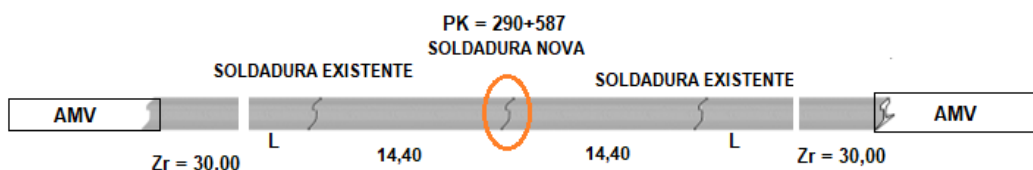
Soldadura no sub-troço R1.
